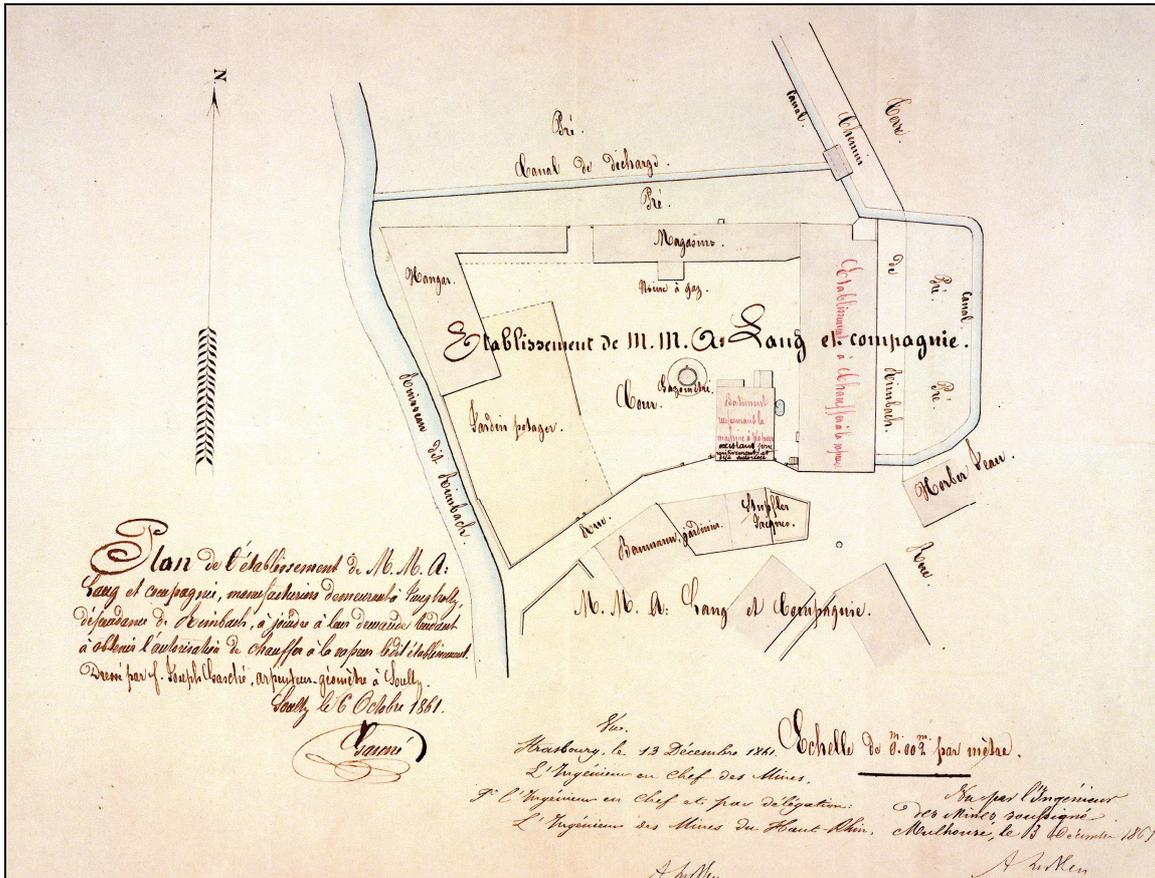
Plan de l'établissement Lang & Cie en 1861 (source, ADHR 5 M 86).
